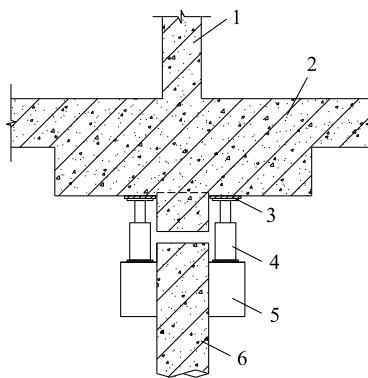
钻孔灌注桩伺服持荷系统示意图
